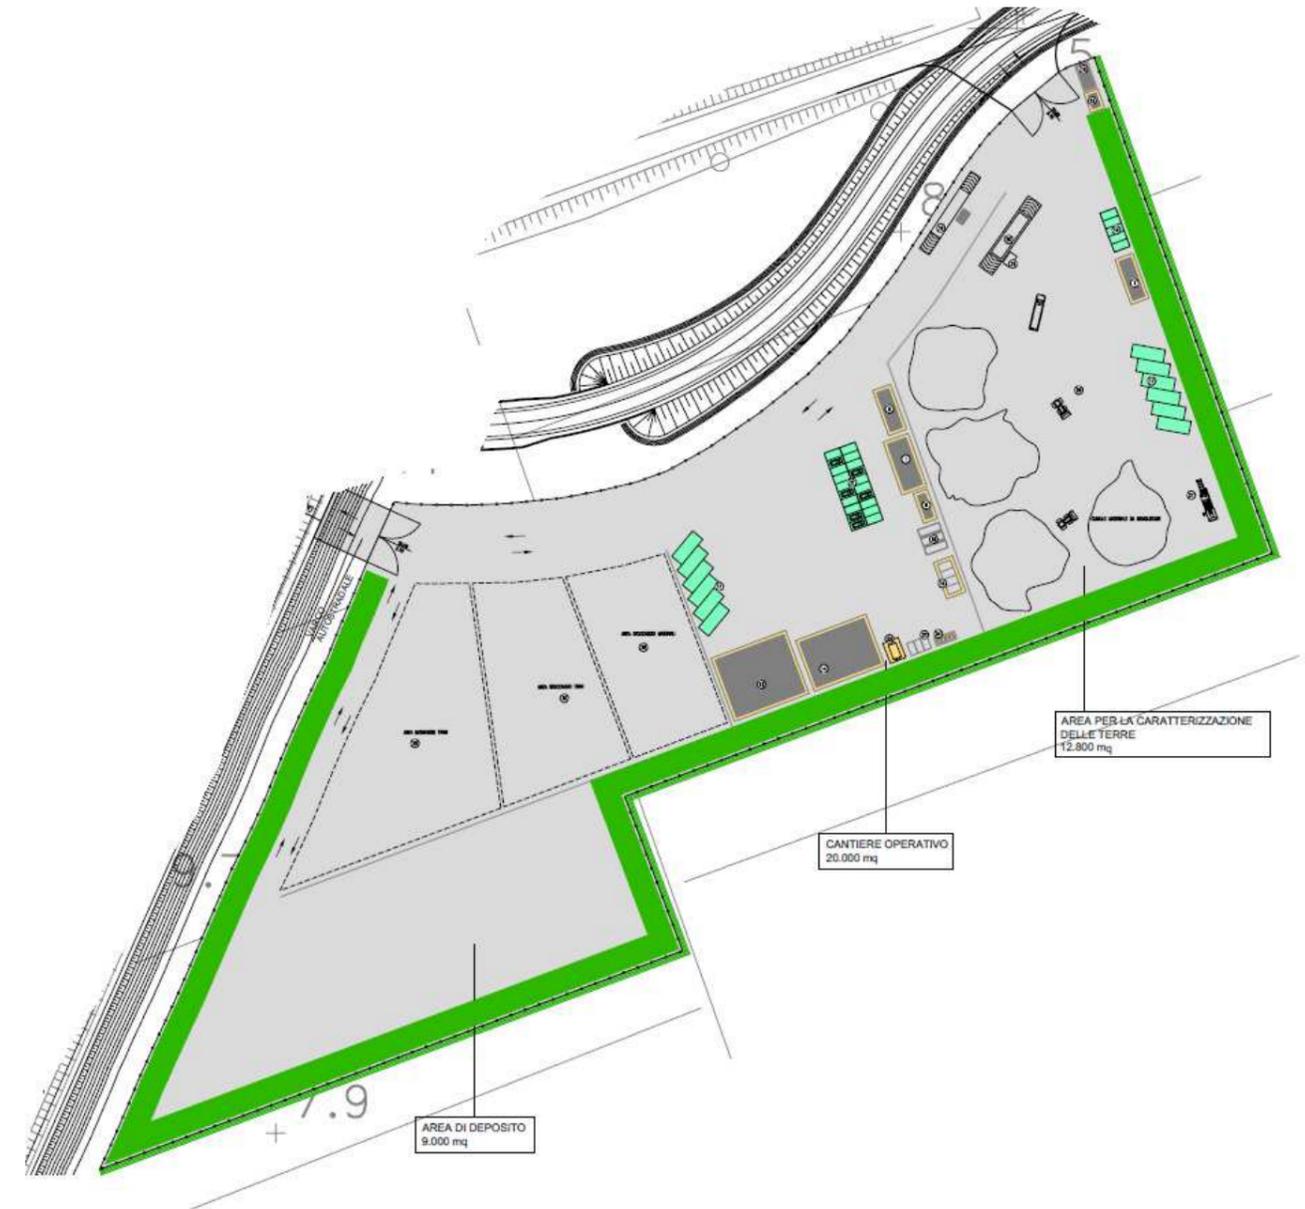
dettaglio dell'organizzazione di un'area di cantiere
